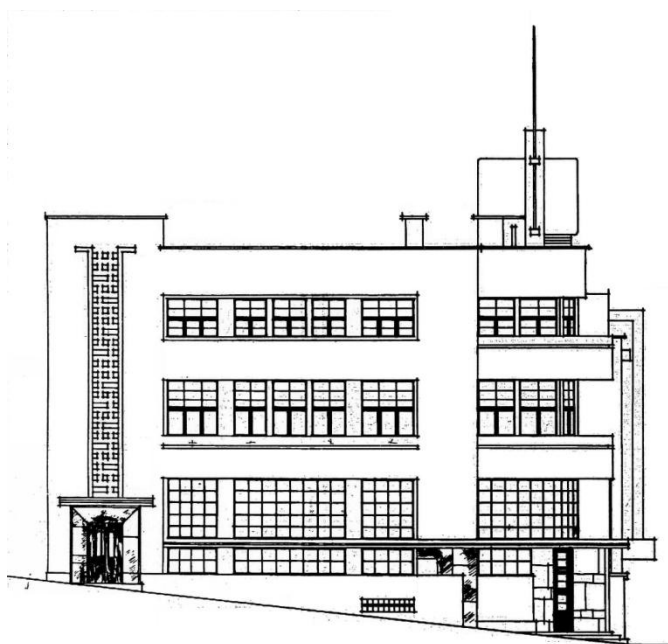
Alçado do projecto da fachada sobre a Rua Dom Pedro V
